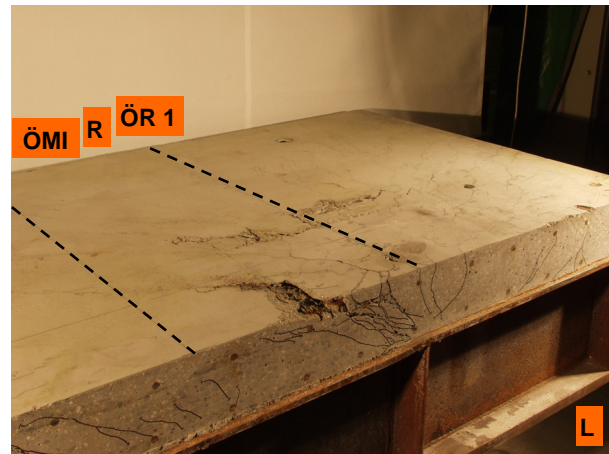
Rissbild auf der Betongurtoberseite und in der unmittelbaren Umgebung der Kopfbolzendübel
